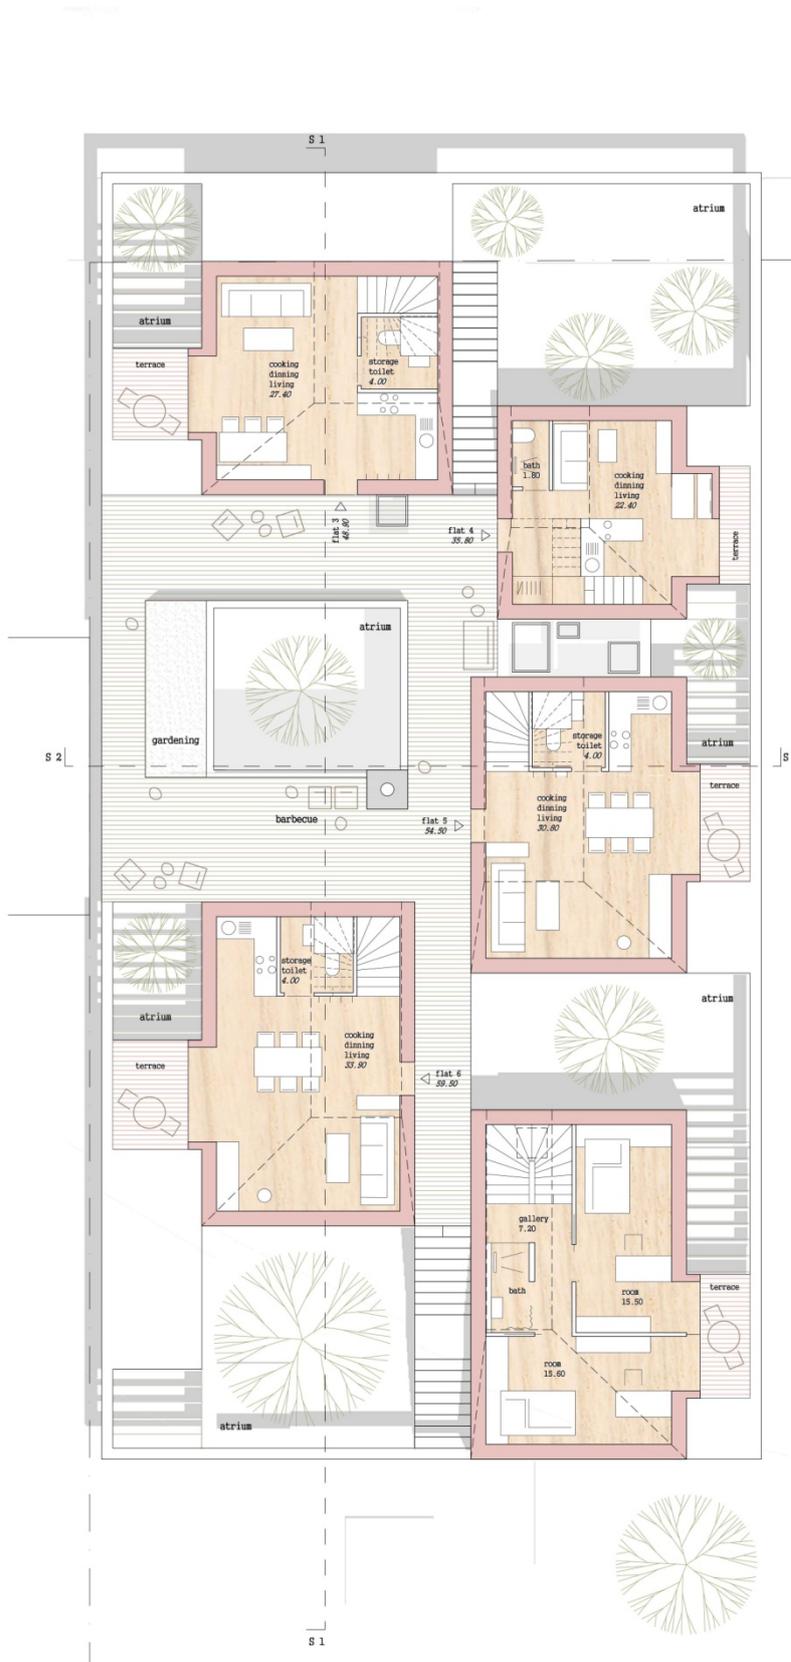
Grundriss 1.Obergeschoss (eigene Darstellung)
